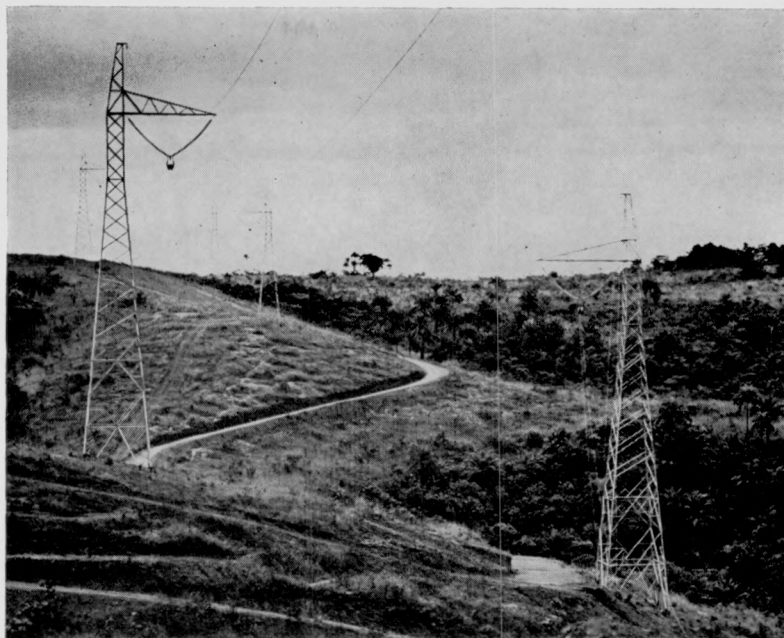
Aspect de la plateforme de ligne en cours de montage.
